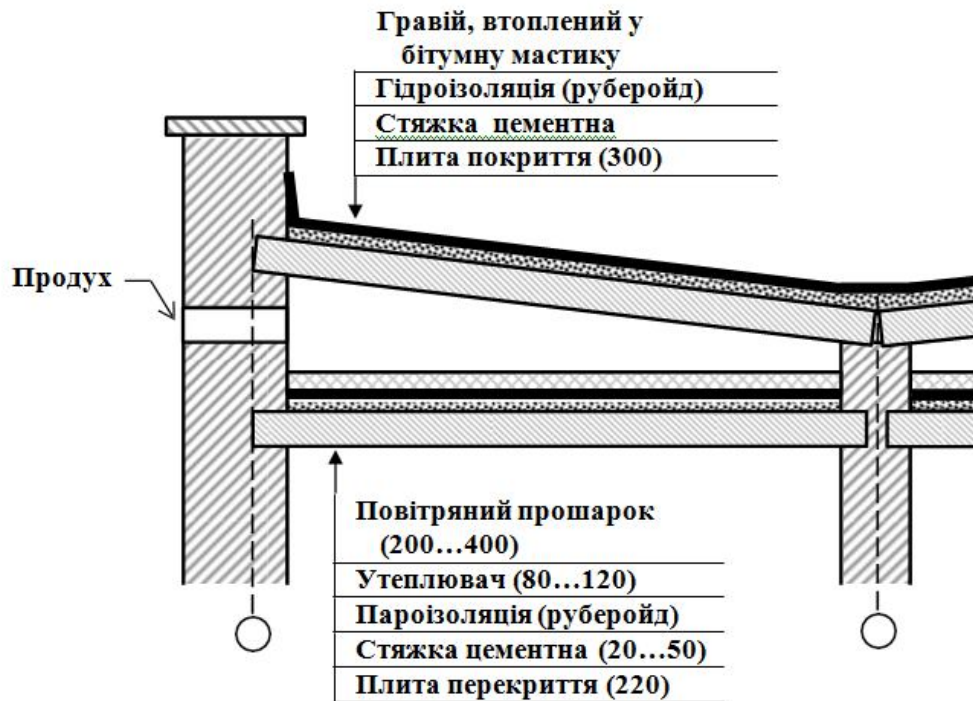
Схема конструкції суміщеного вентилязованого даху.
